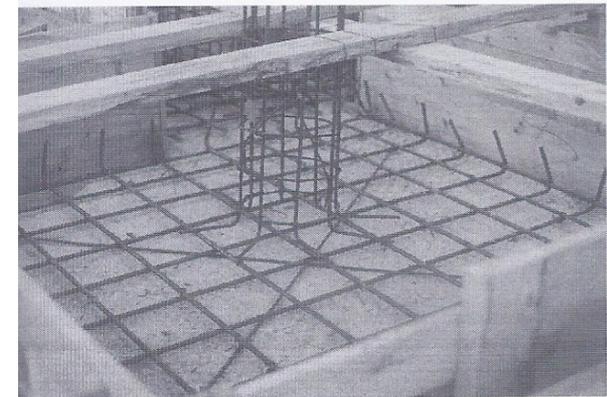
ZAPATA AISLADA ENCOFRADA CON MADERA.
